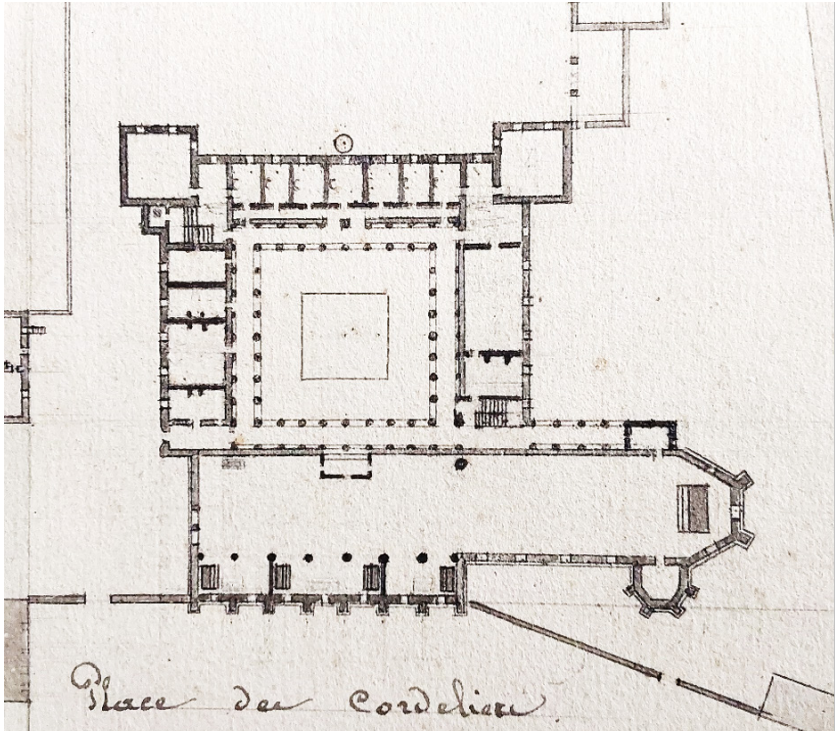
▶ Plan Deklier-Dellile, 1764, couvent des cordeliers. Coll. de l'auteur
